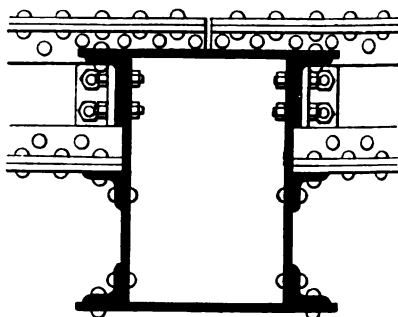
Poutres tubulaires recevant des poutres simples.
